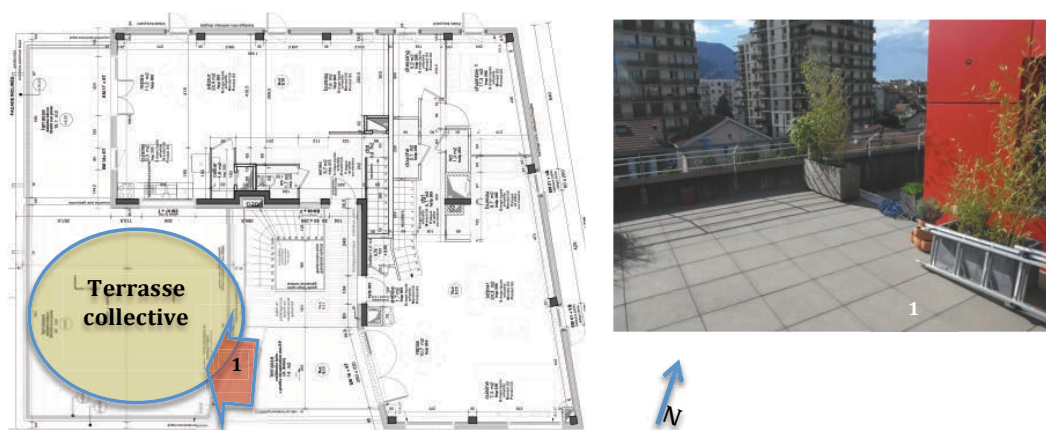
Terrasse sur le toit, opération « la Salière, plans TEHKNE, photo E. RUIZ.
